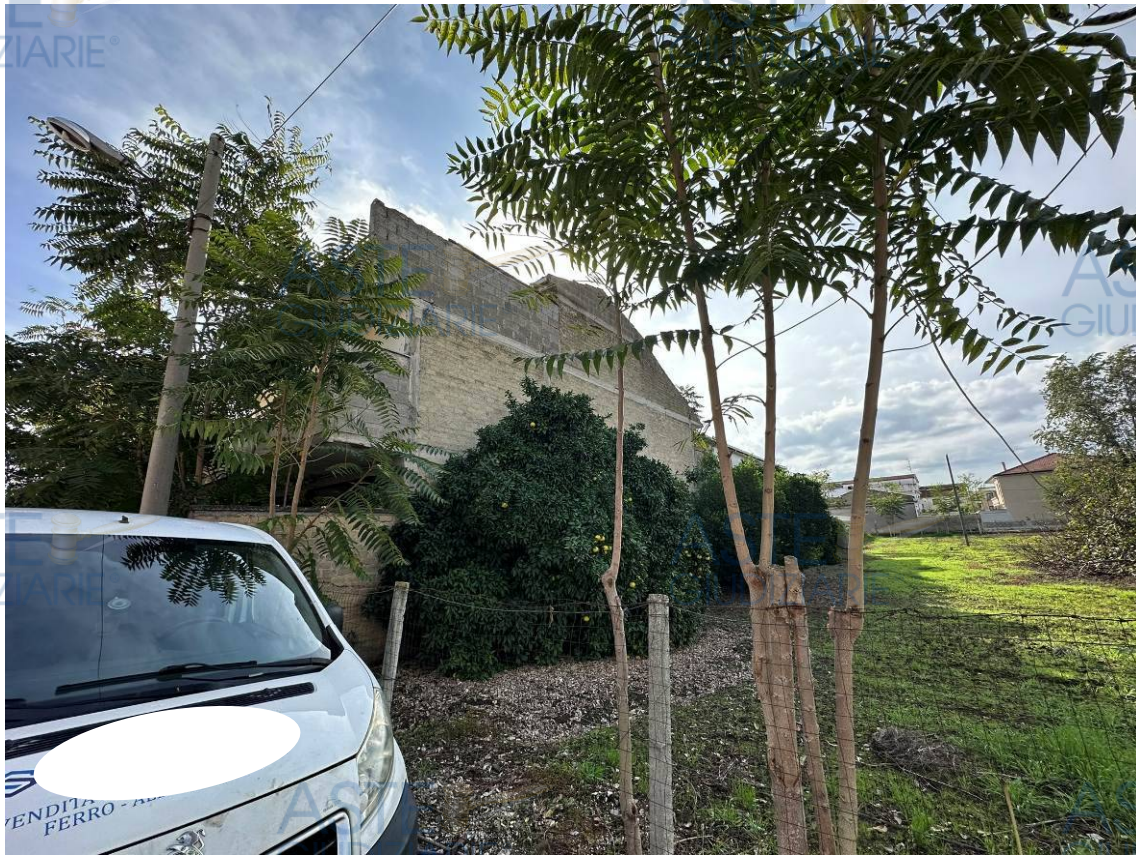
Lo stabile dalla via G. Savonarola – lato Ovest
